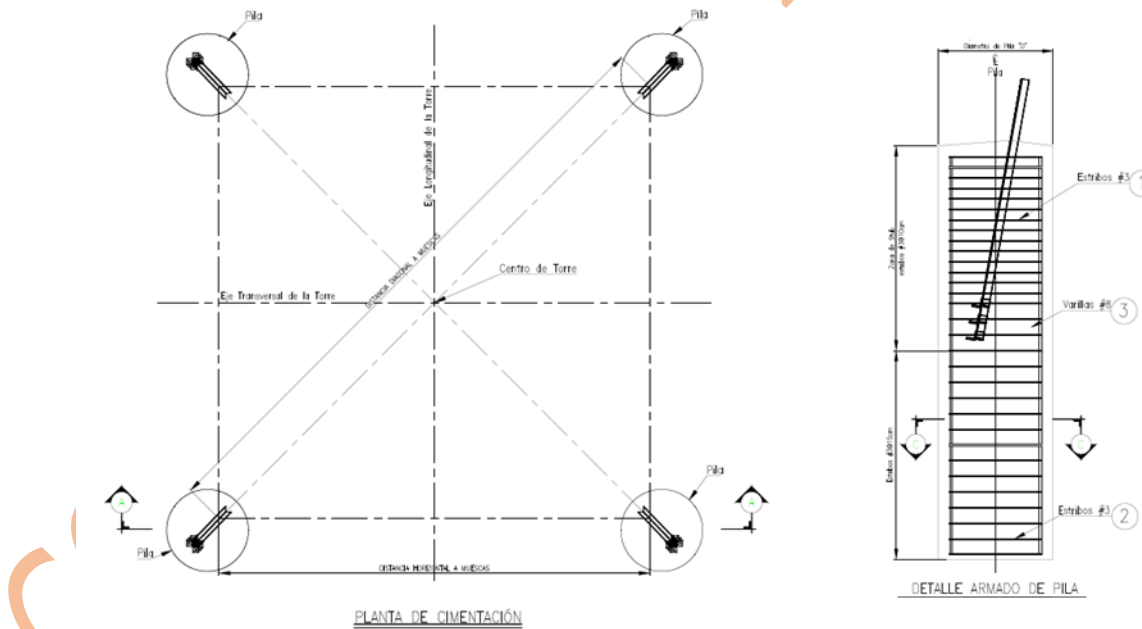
Planta y detalle de cimentación de estructuras de soporte para Línea de interconexión.
